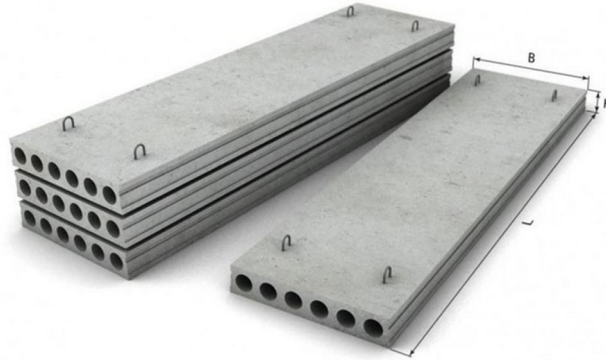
Вид залізобетонної багатопустотної плити перекриття
